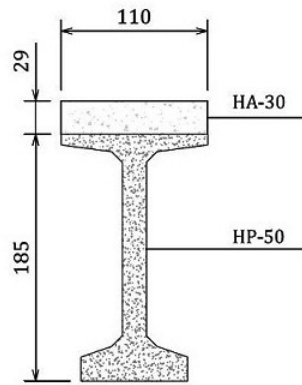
Sección de las vigas que conforman el tablero de la pérgola. Cotas en cm.
